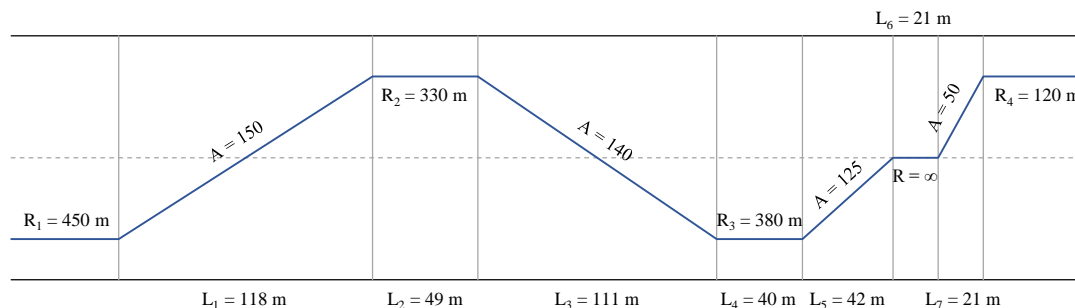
Exemplo do traçado em planta de um trecho de estrada (adaptado de JAE, 1994)
